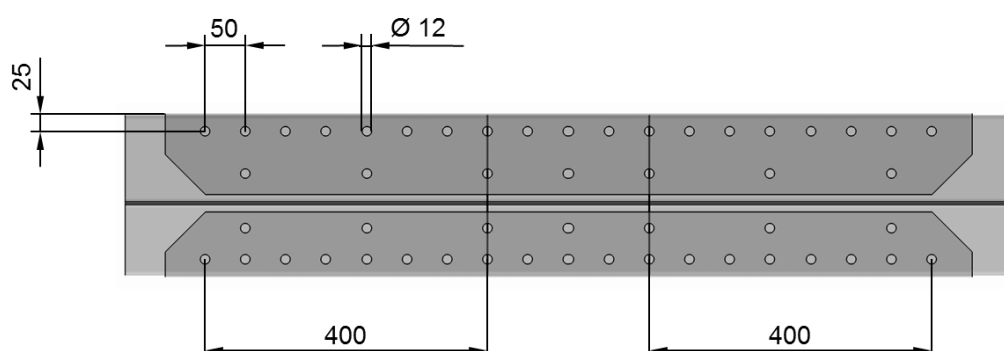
Размеры отверстий для сварки в усиливающих накладках
